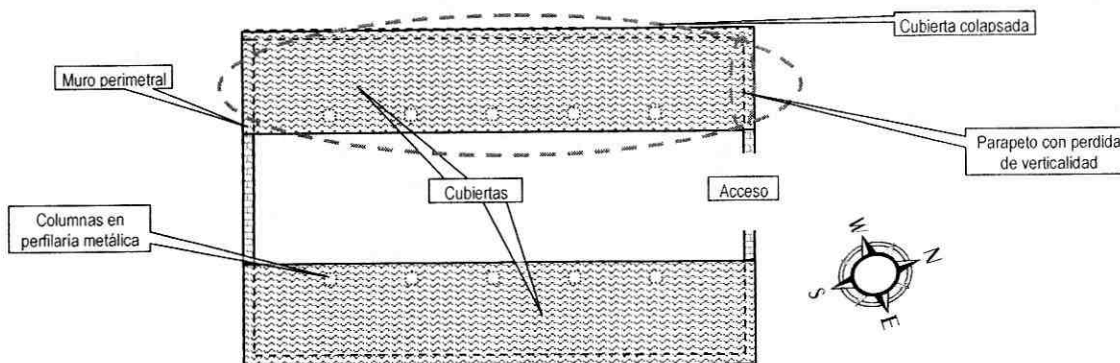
Esquema de distribución del predio de la Calle 13 A # 81F-13
